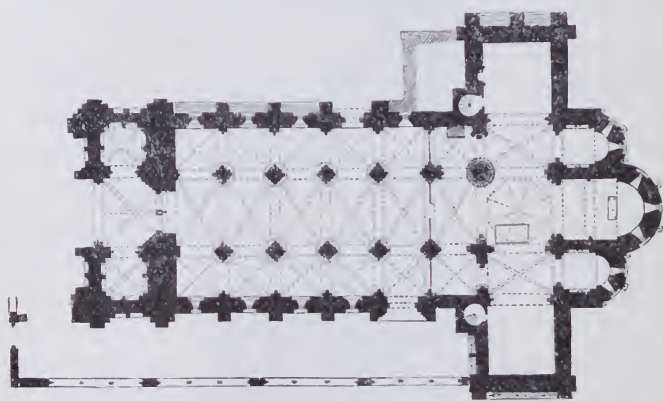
Grundriss von S. Vicente zu Avila.
